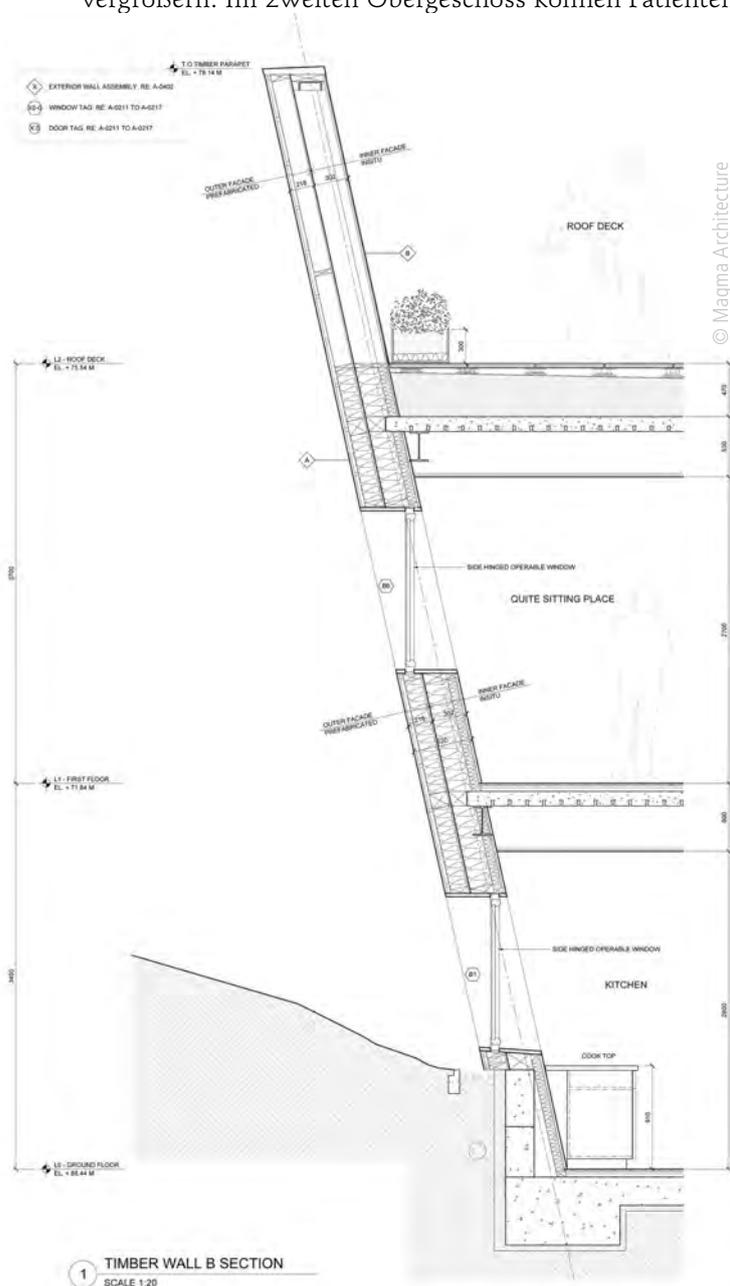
Detailschnitt Fassade und Geschossdecken mit Fenstereinbauten und Dachterrasse
